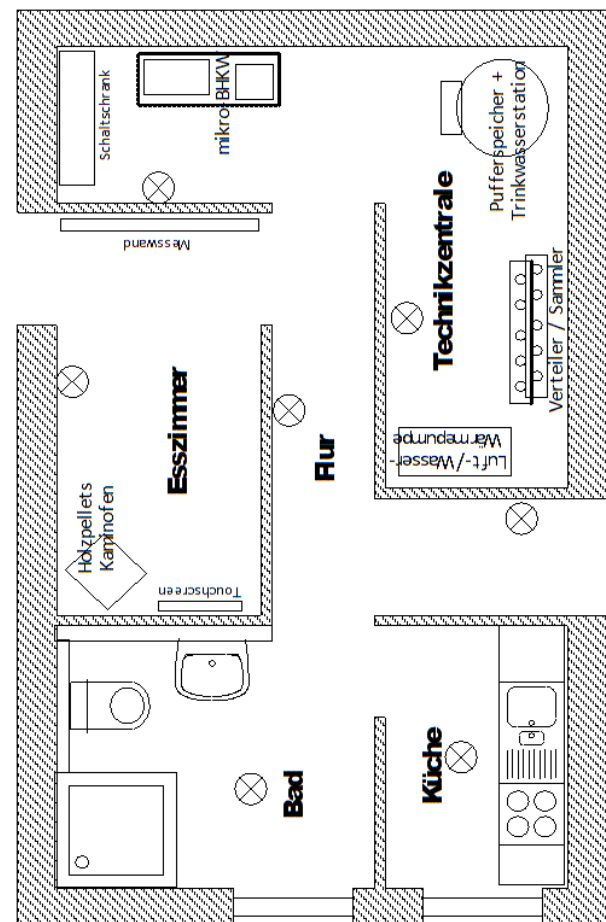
Grundriss des ESIH mit technischen Komponenten (ohne KWL + Solarthermie)
